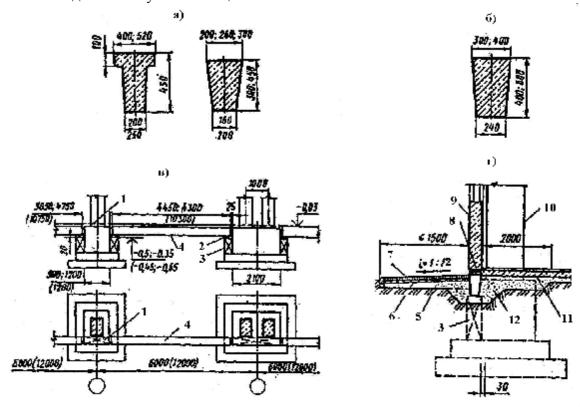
Фундаментные балки (а – при шаге колонн 6 м; б – при шаге колонн 12 м; в – опирание балок; г – детали фундамента наружного ряда колонн): 1– набетонка толщиной 12 см; 2 – слой раствора толщиной 20 мм; 3 – опорный столбик; 4 – фундаментная балка; 5 – песок; 6 – щебёночная подготовка толщиной 13–15 см; 7 – асфальт 1,5–2 см; 8 – гидроизоляция; 9 стеновая панель; 10 – колонна; 11 – подстилающий слой; 12 – шлак
